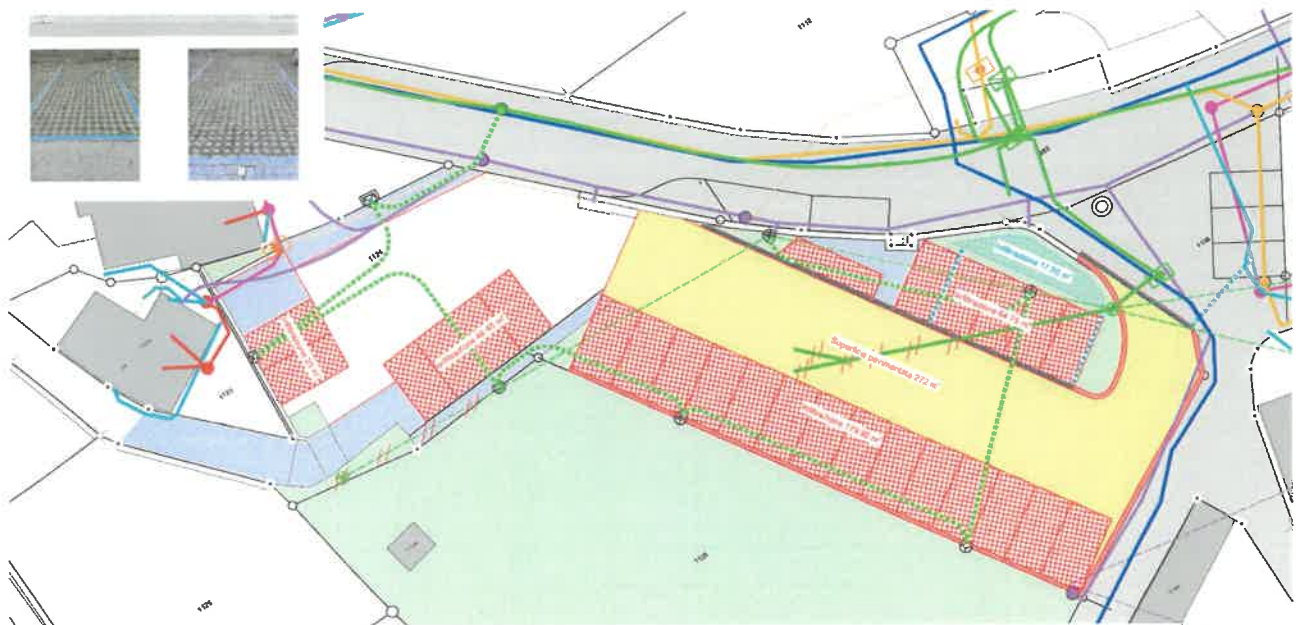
planimetria infrastrutture di progetto, in verde l'illuminazione pubblica, in azzurro lo smaltimento delle acque meteoriche.
